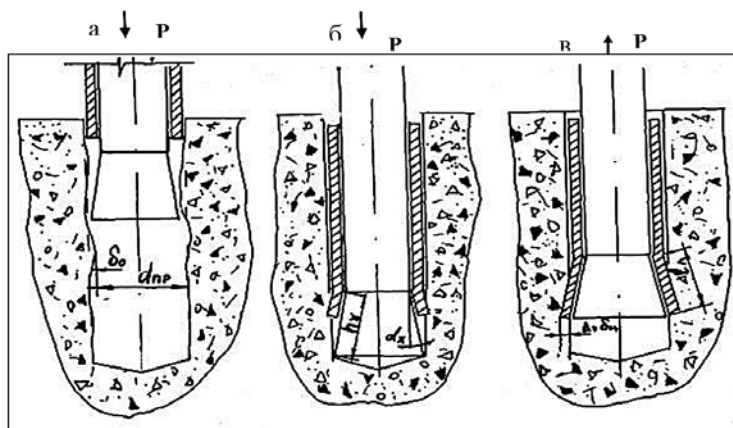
Схема установки: а – расклинивания; б и в – затяжки крепления типа IV
